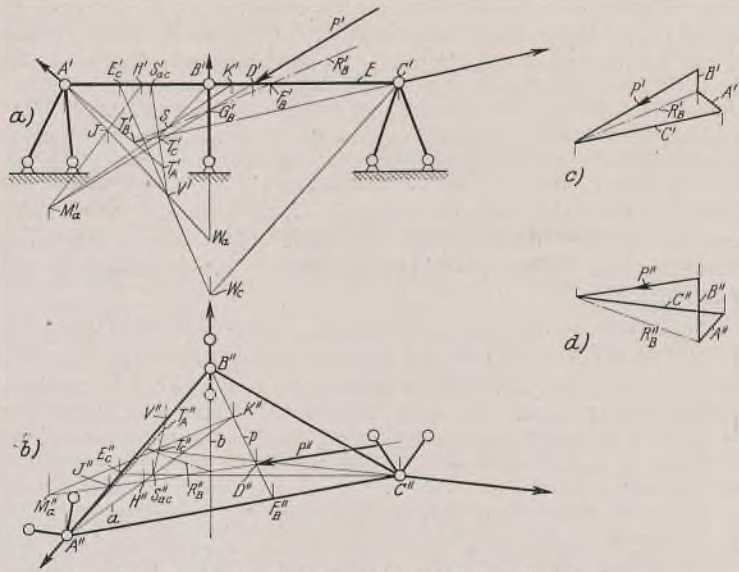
u. b. Auf- und Grundriß des Fachwerks.
